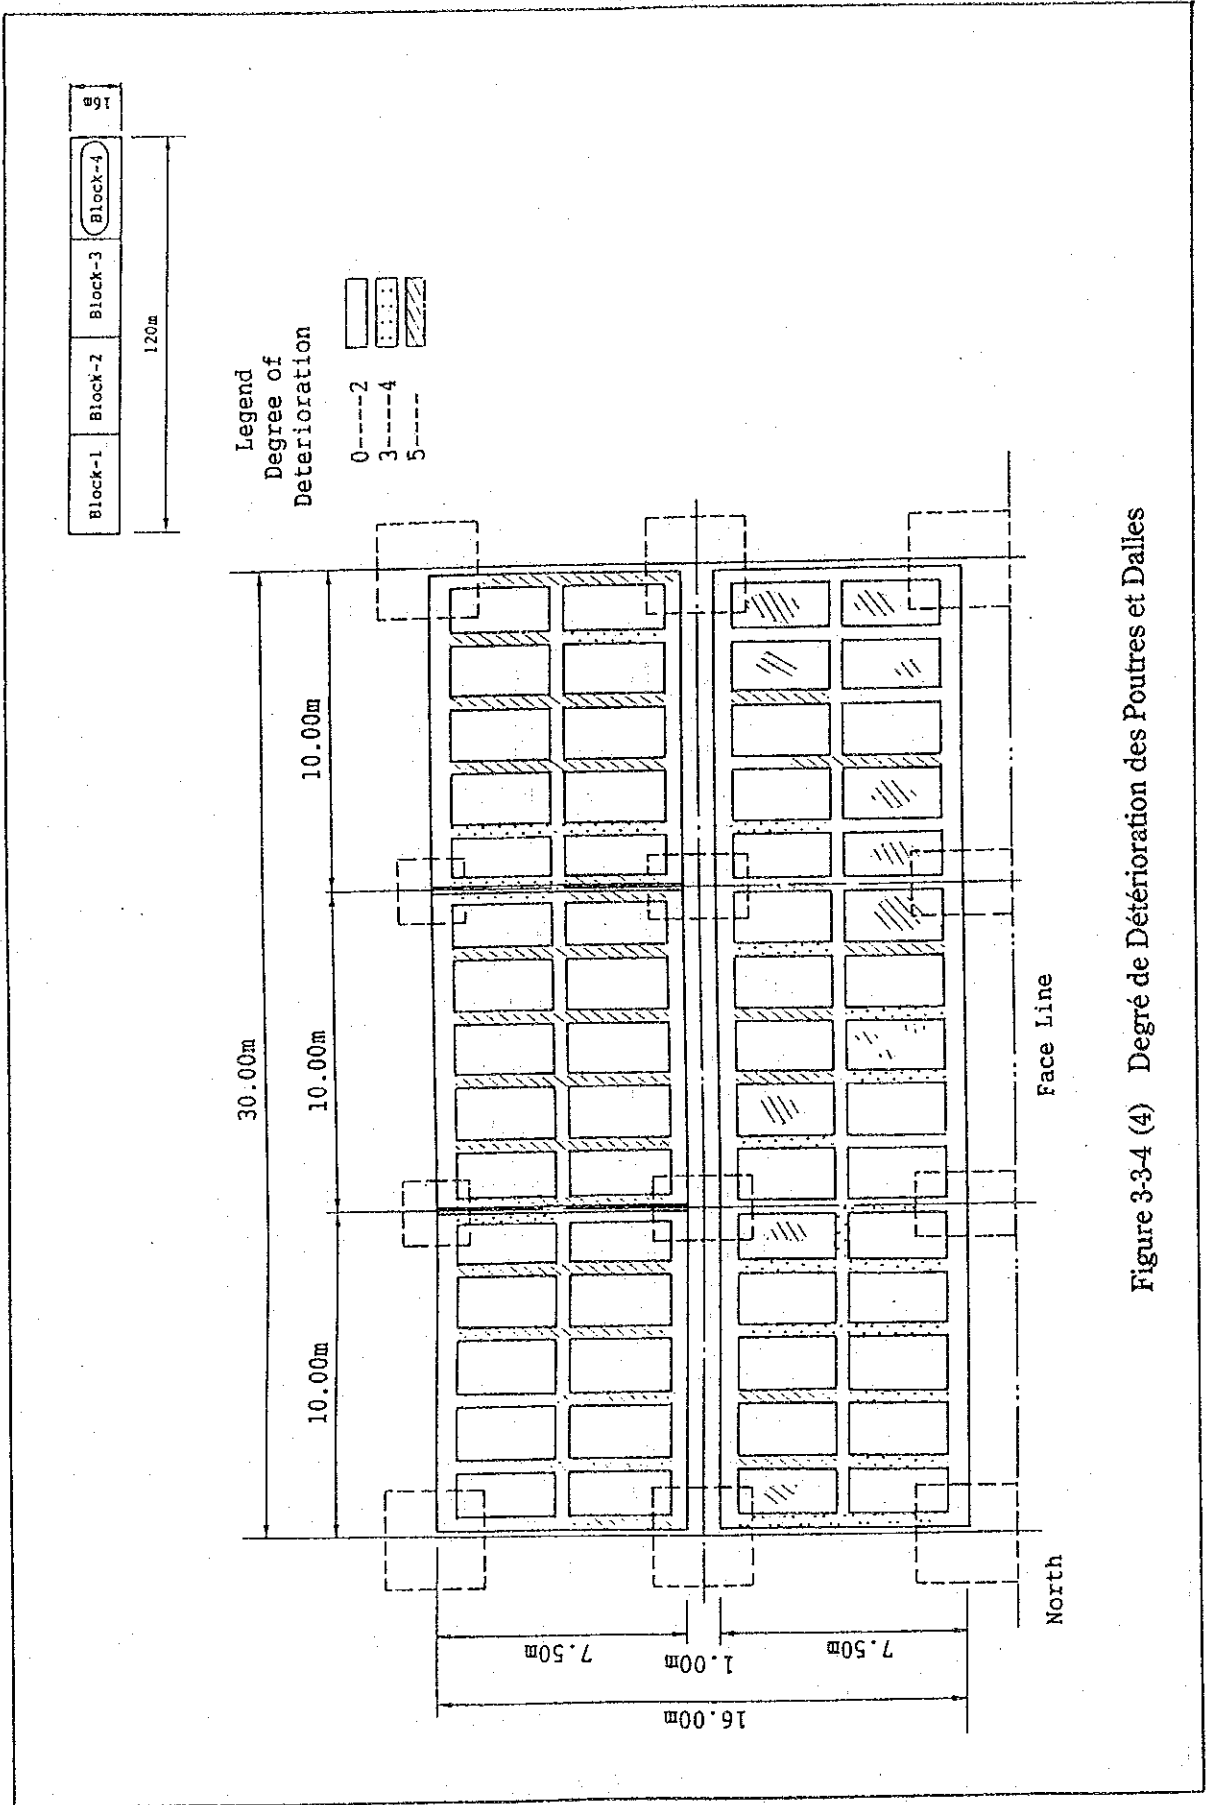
(4) Degré de Détérioration des Poutres et Dalles
